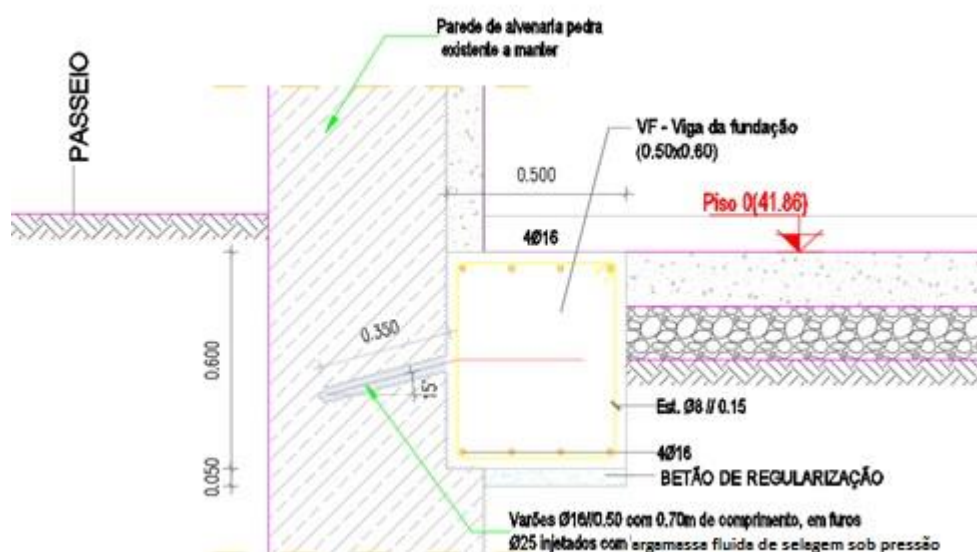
Pormenor da viga de fundação e respectivas fixações do edifício do Lardo das Olarias nº 35 a 42
